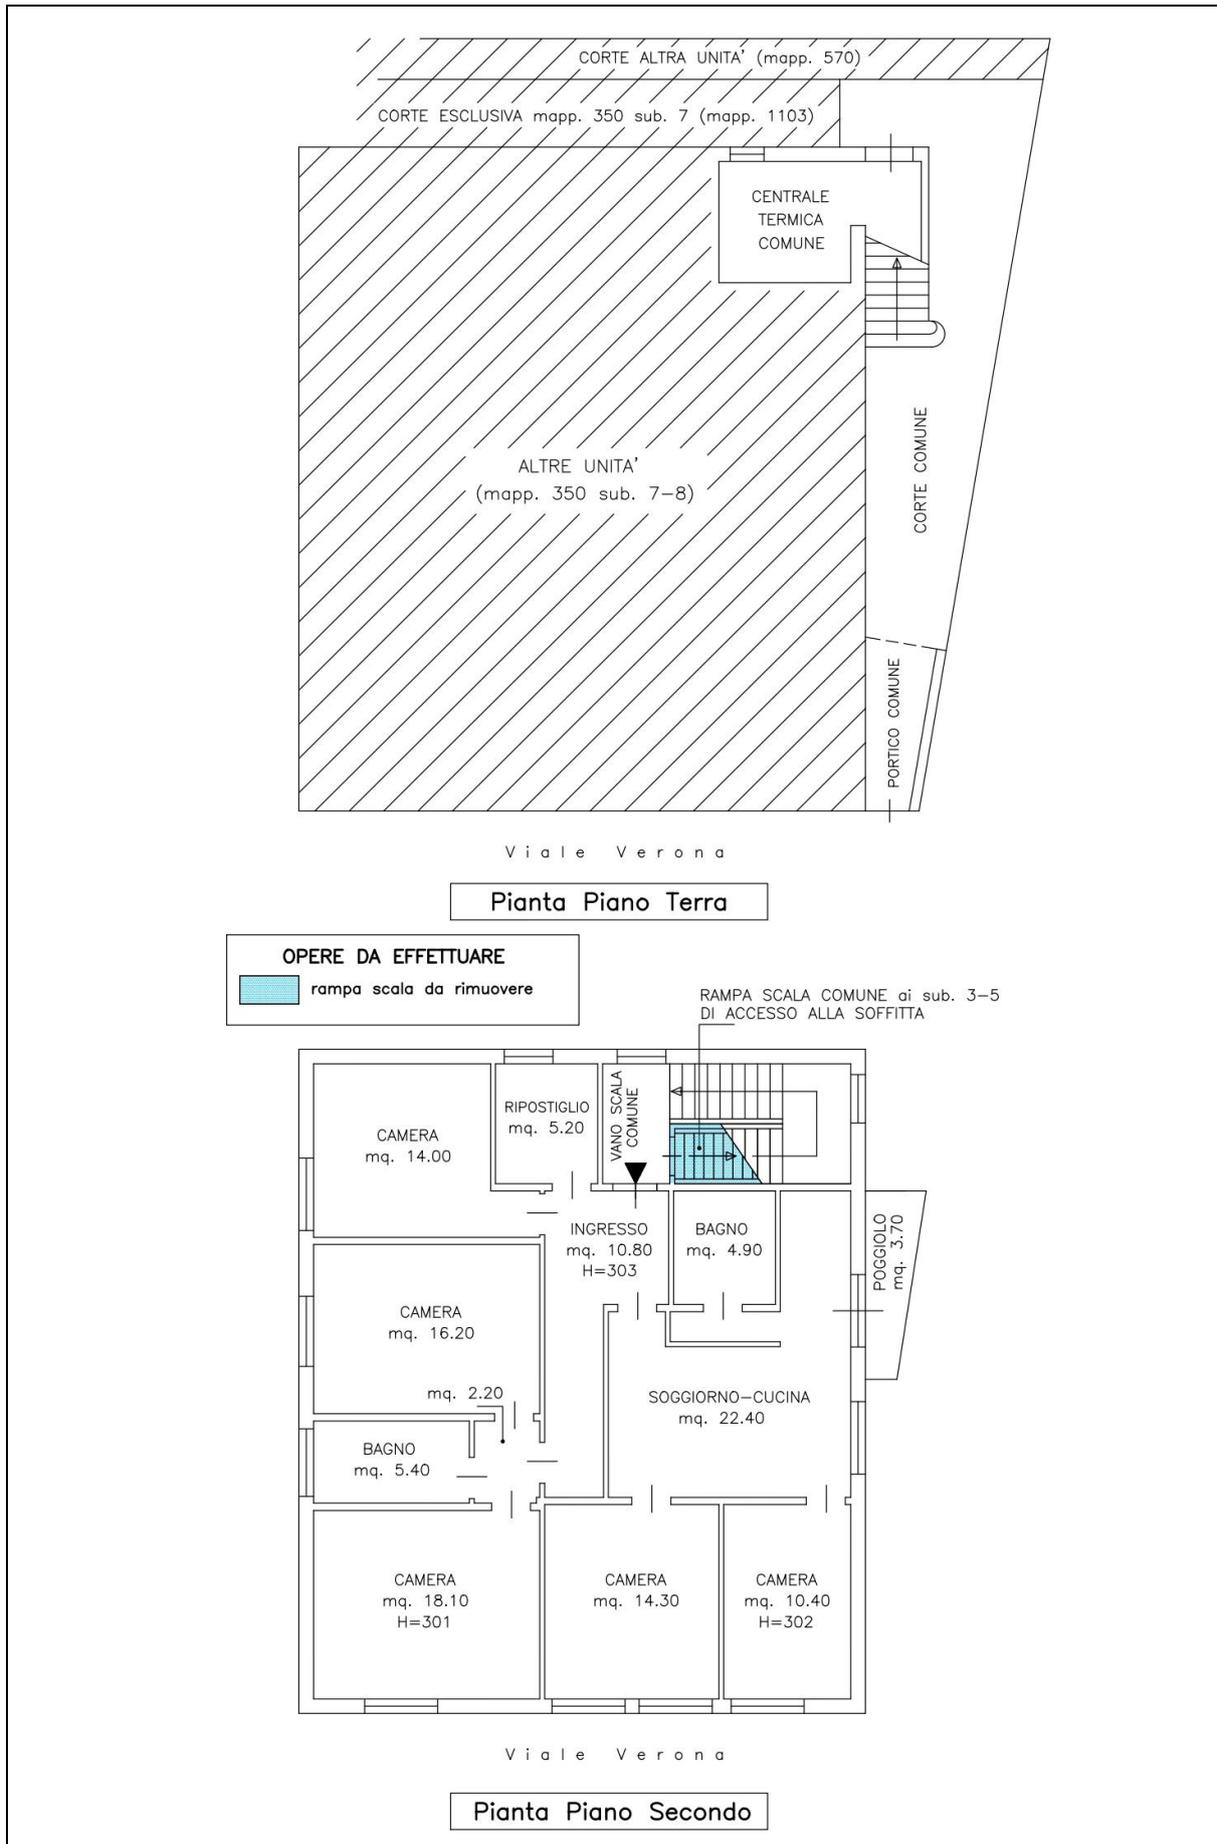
a. Planimetrie immobile – Piani Terra e Secondo.
